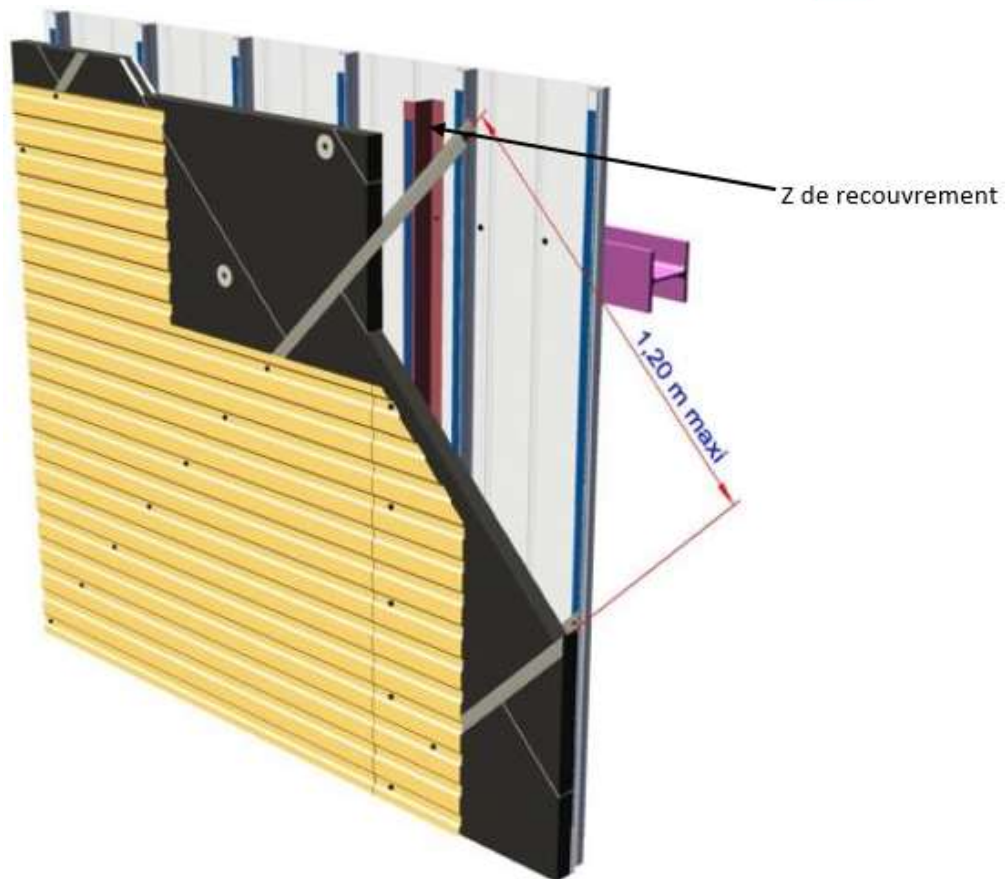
Z de recouvrement pour un bardage avec plateaux verticaux, Z à 45° et peau d'étanchéité horizontale
